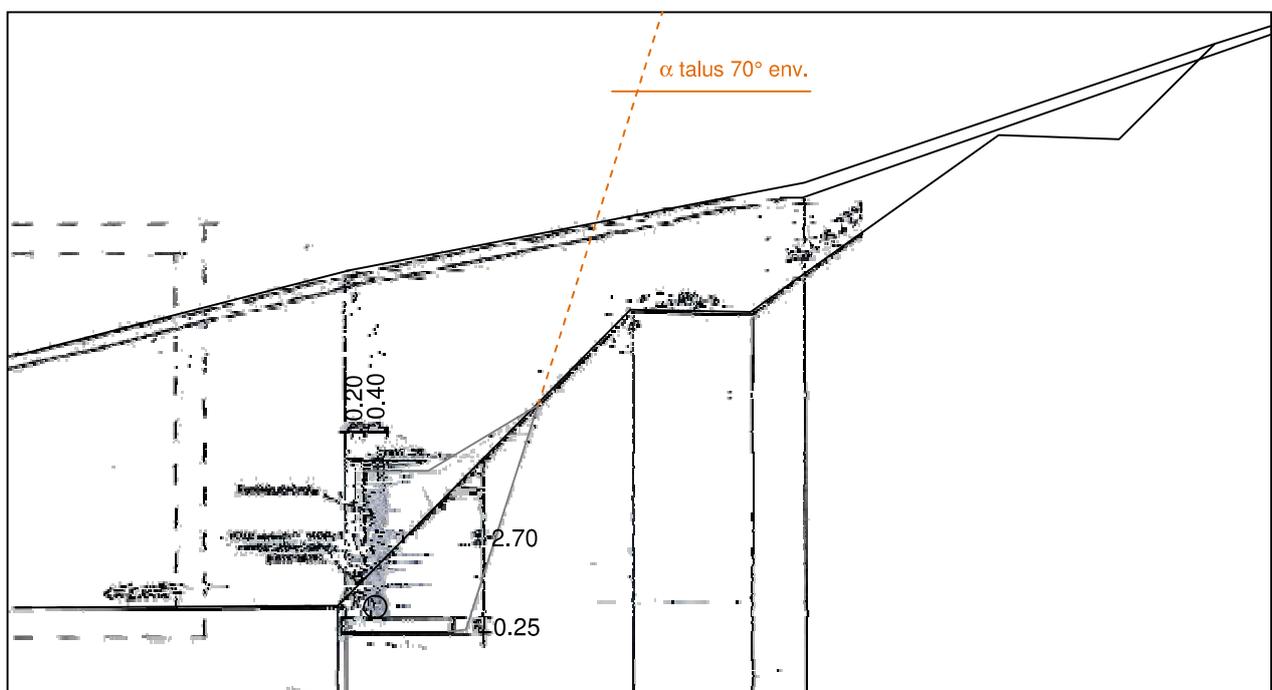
Coupe A-A (plan MS-01, DCE Ind.0, 25/05/2020)
